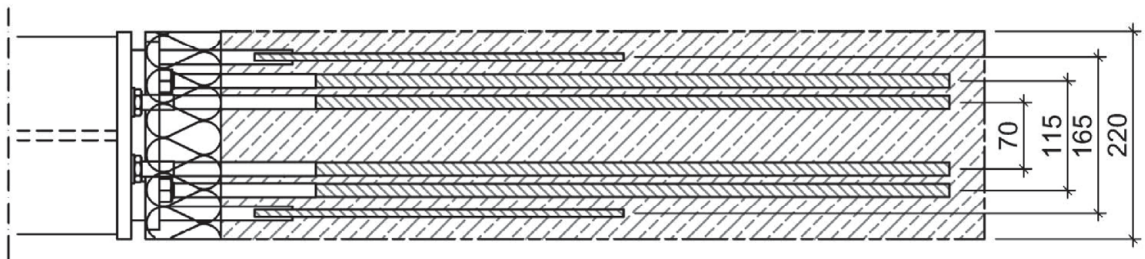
Grundriss IP 80 SM14 QQ
